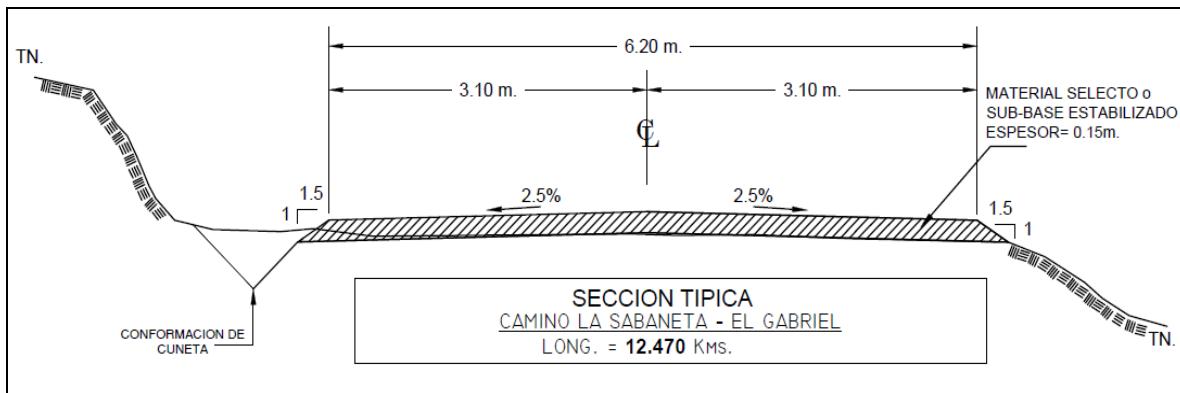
Sección Típica del Camino La Sabaneta – El Gabriel; Long: 12.47 km.
